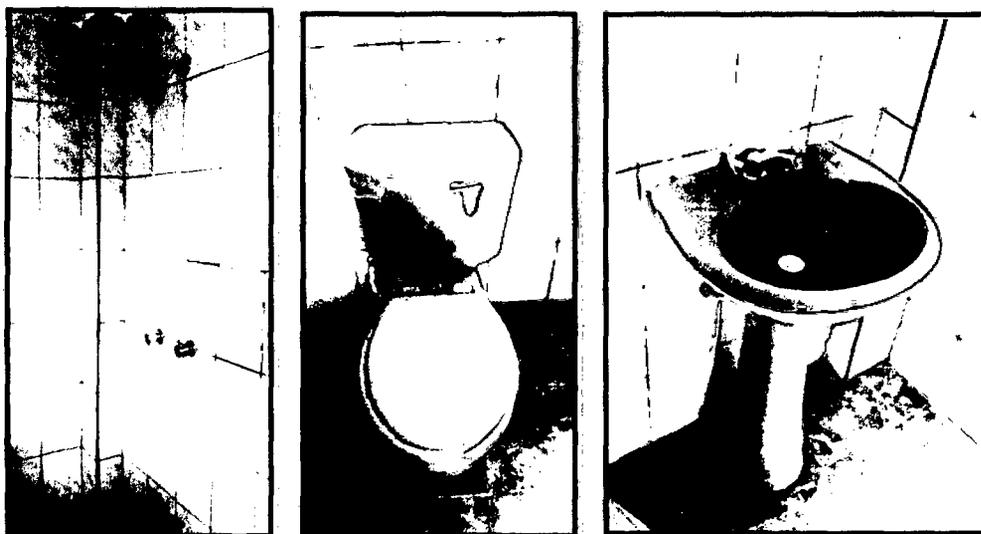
Ducha, inodoro y lavatorio en el cuarto de baño con sus accesorios y válvulas en buen estado características en todas las unidades básicas de saneamiento.
